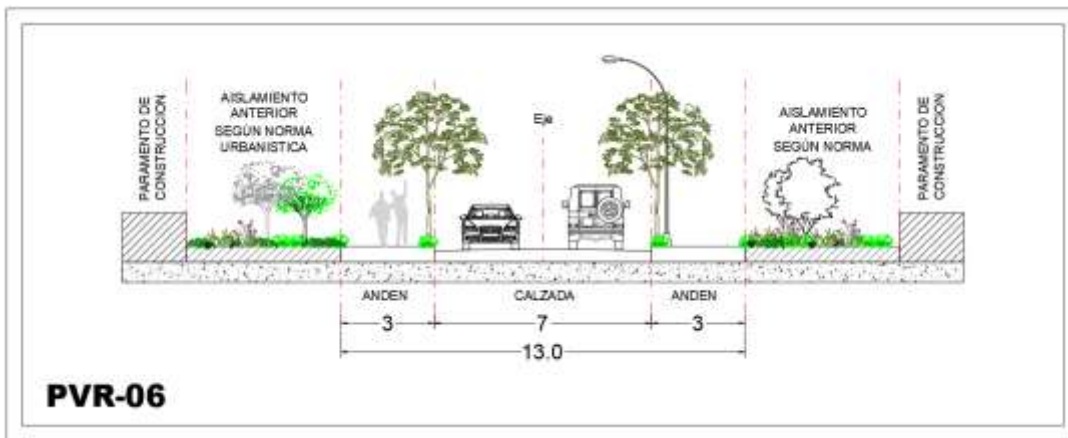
Perfil PVR-06 articulación rural con suelos de desarrollo restringido.
